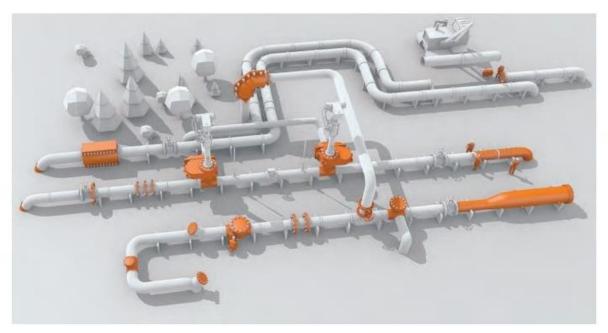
Схема технологии врезки и перекрытия трубопровода
